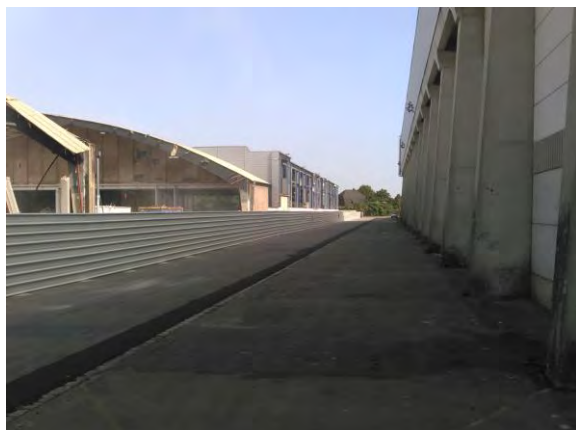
Vue sur la façade ouest du Rhénus sport ainsi que sur le Hall 20 qui est en cours de démolition
